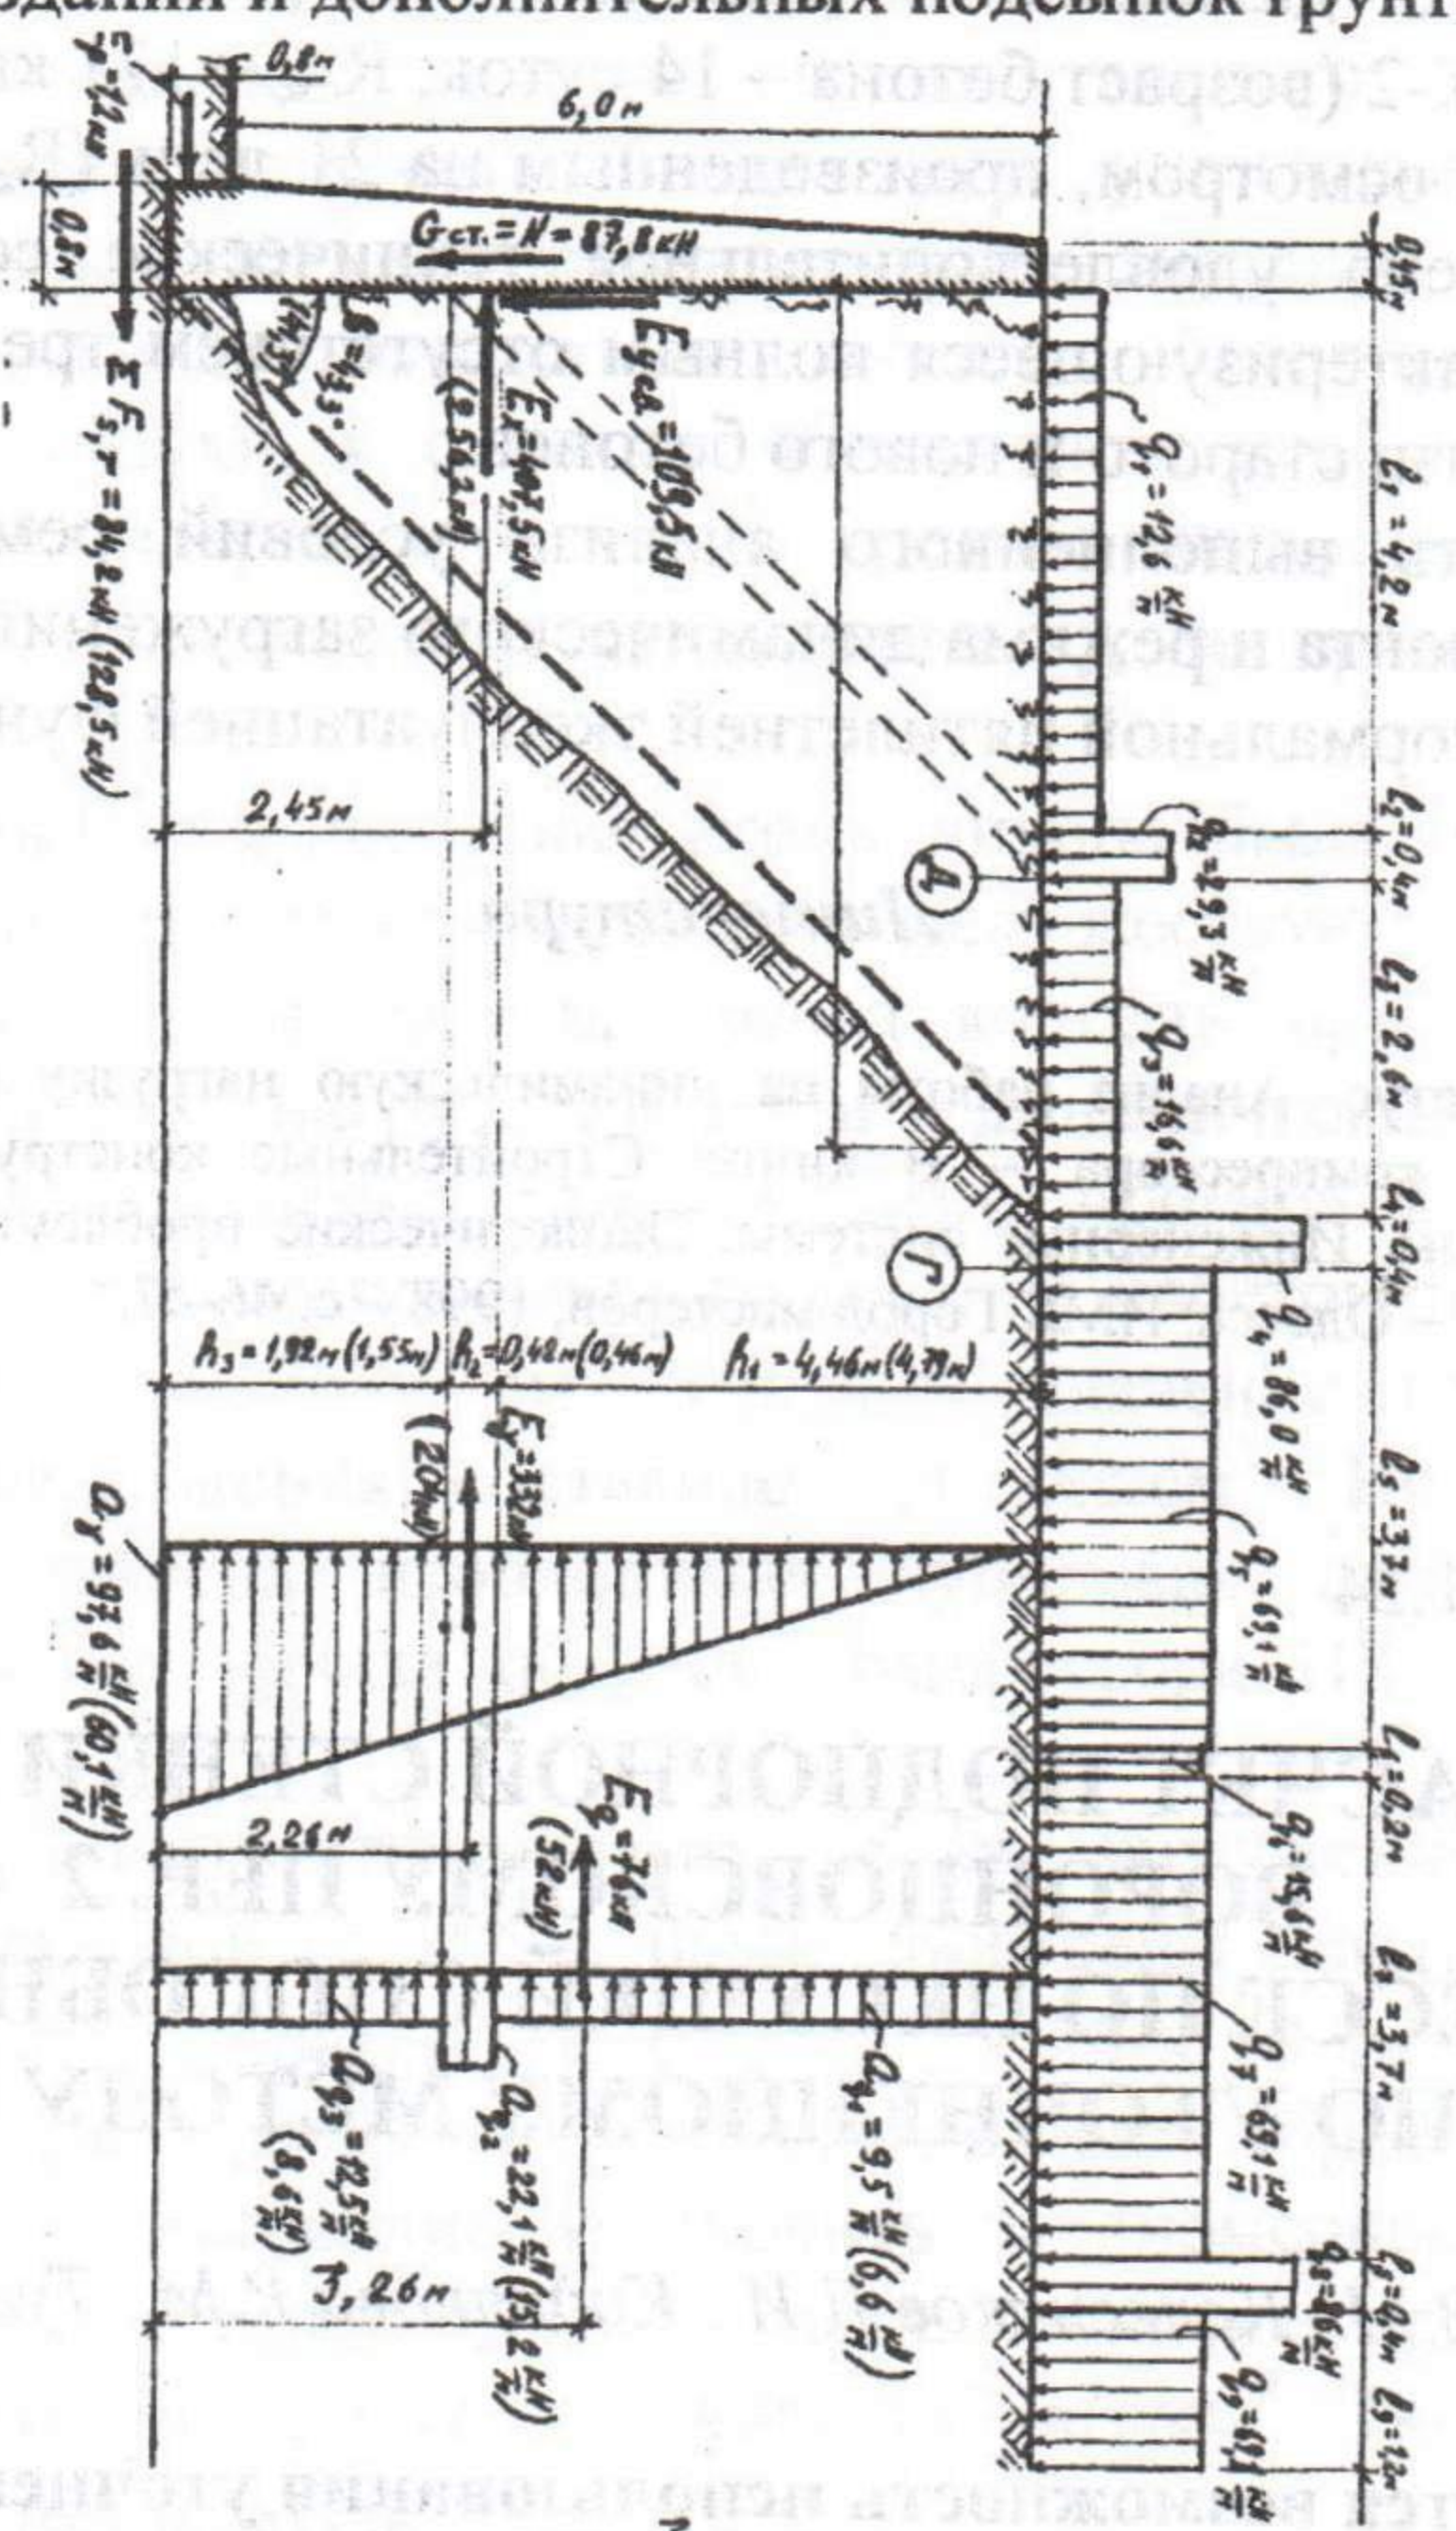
Расчетная схема подпорной стенки с учетом действия реальных полосовых нагрузок на поверхности засыпки, состоящей из несвязных (связных) грунтов
